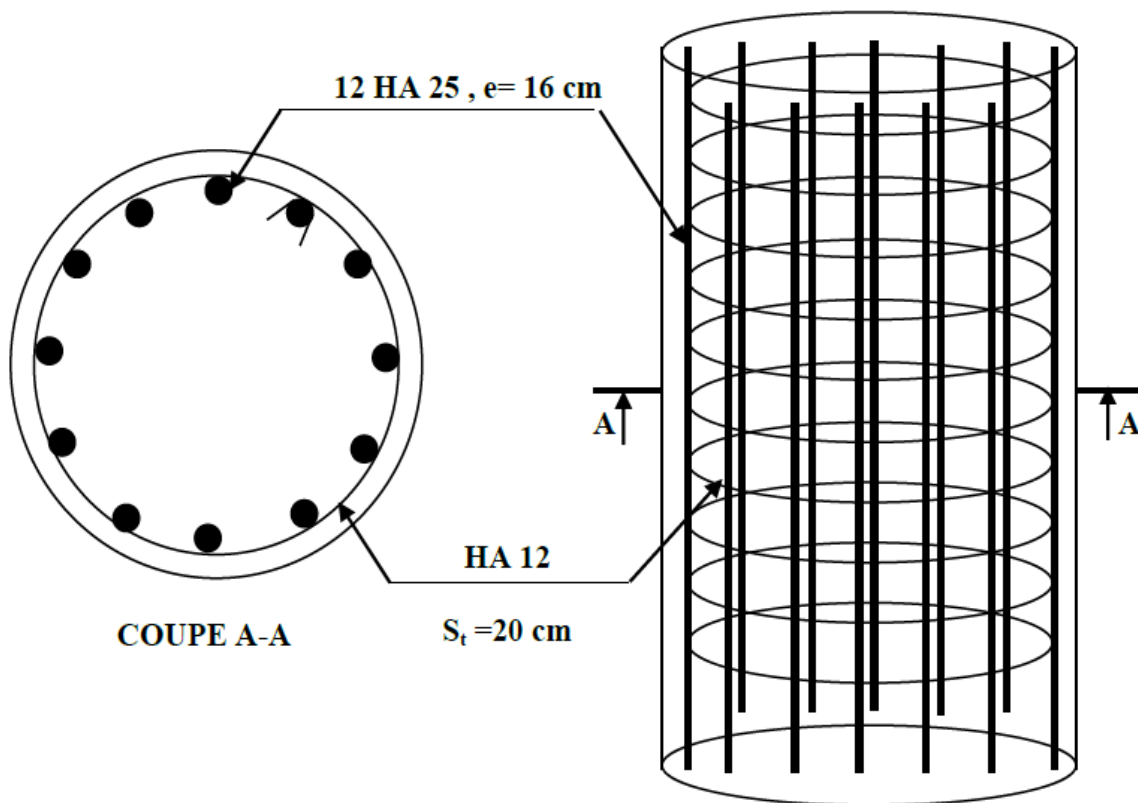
Schéma de Ferrailage du pieu.
